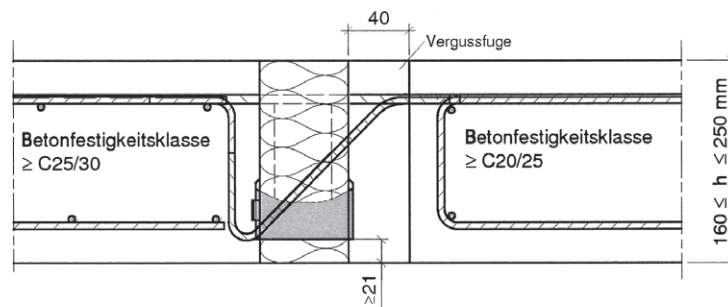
Beispiel Schöck Isokorb Typ RK-240
